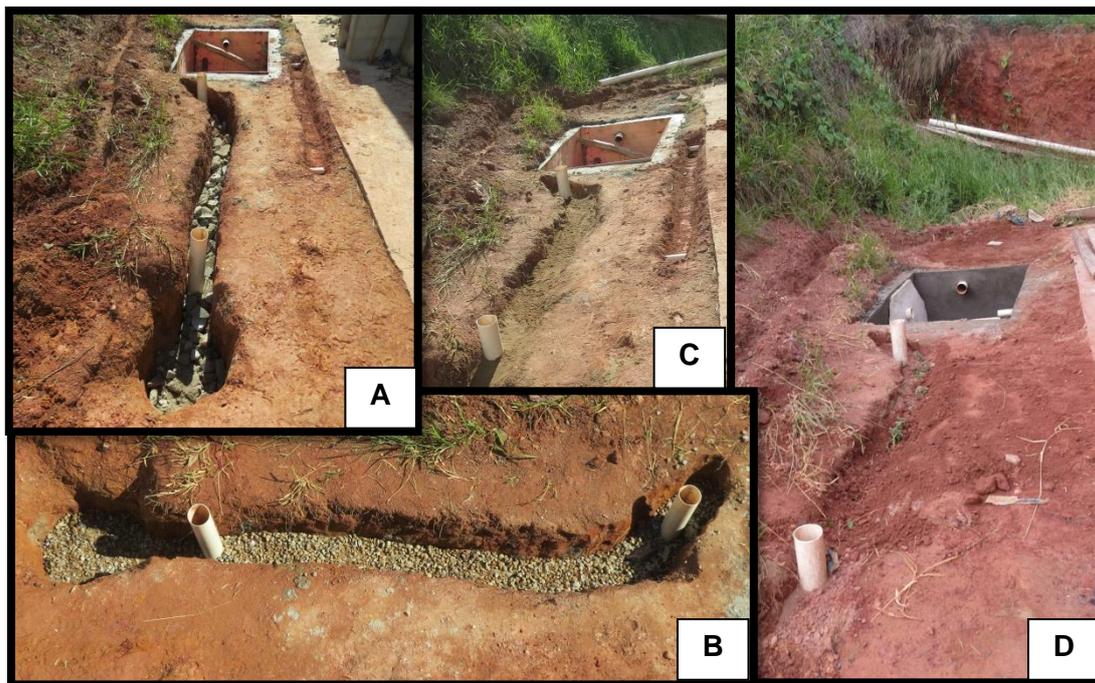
Preenchimento do poço de infiltração e da zona de raízes.
